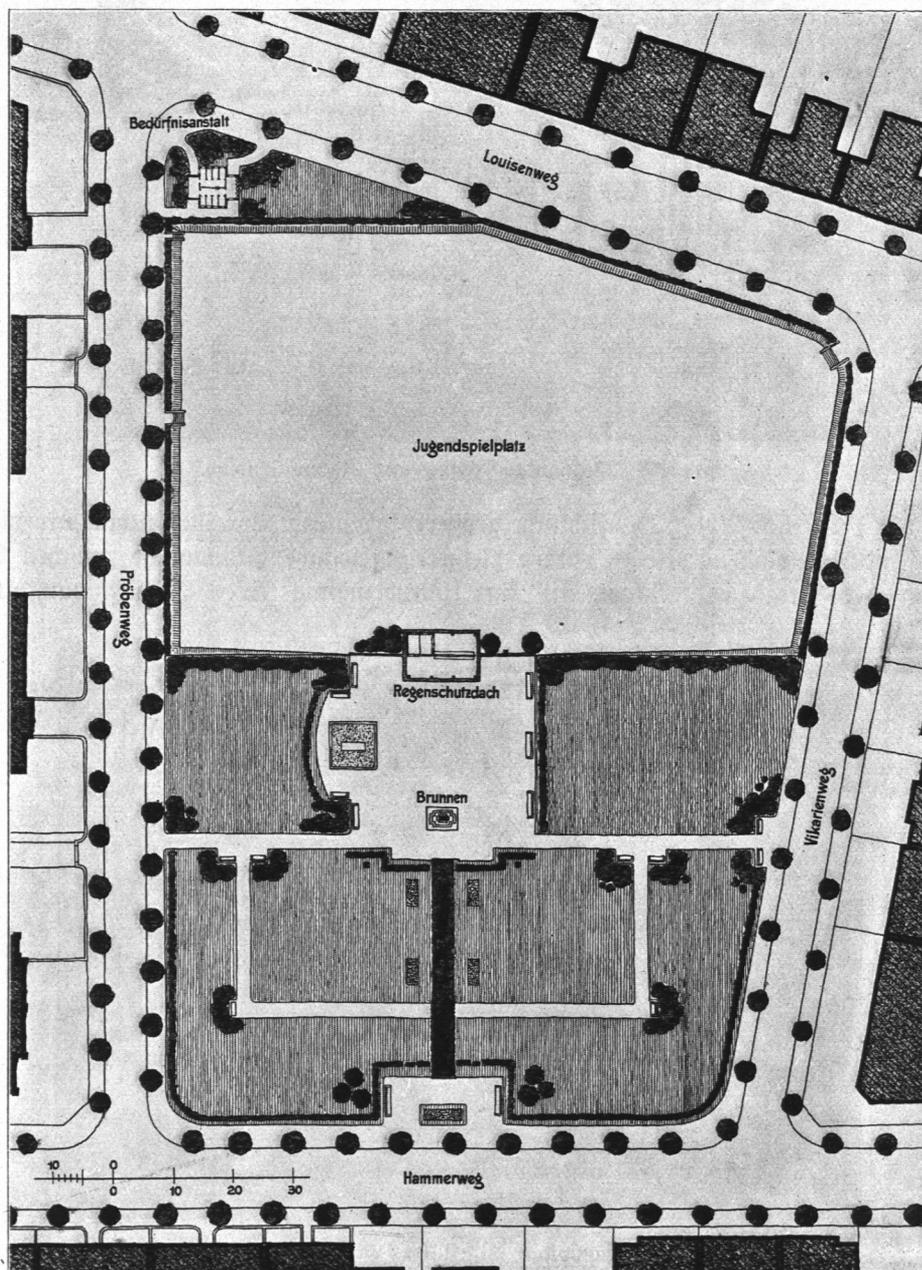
Grünanlage Luitjenweg, Lageplan.
